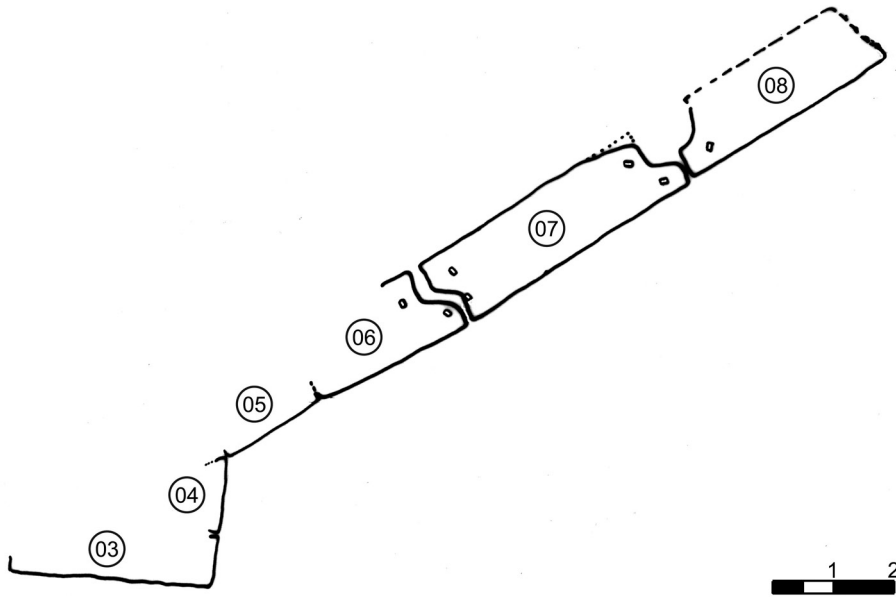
Block 03 bis 08. Grundriss Detail
